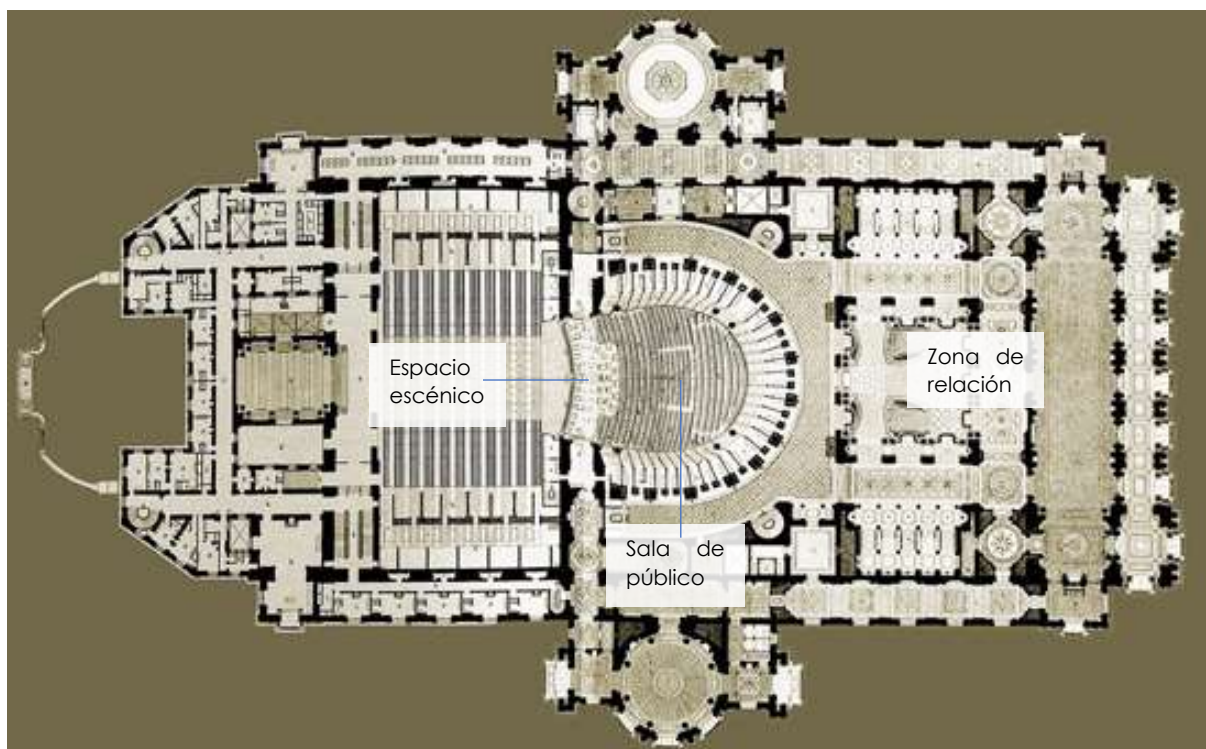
Planta Ópera de París, Charles Garnier, 1861
